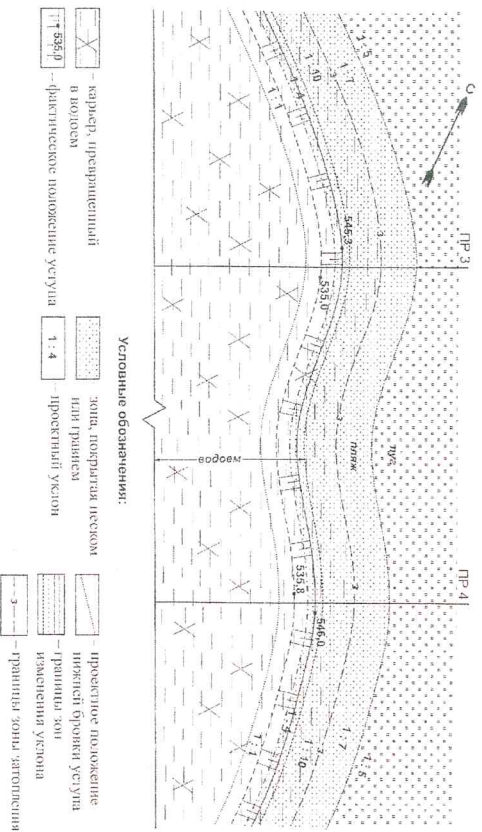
План пляжной зоны водоема в открытом карьере
